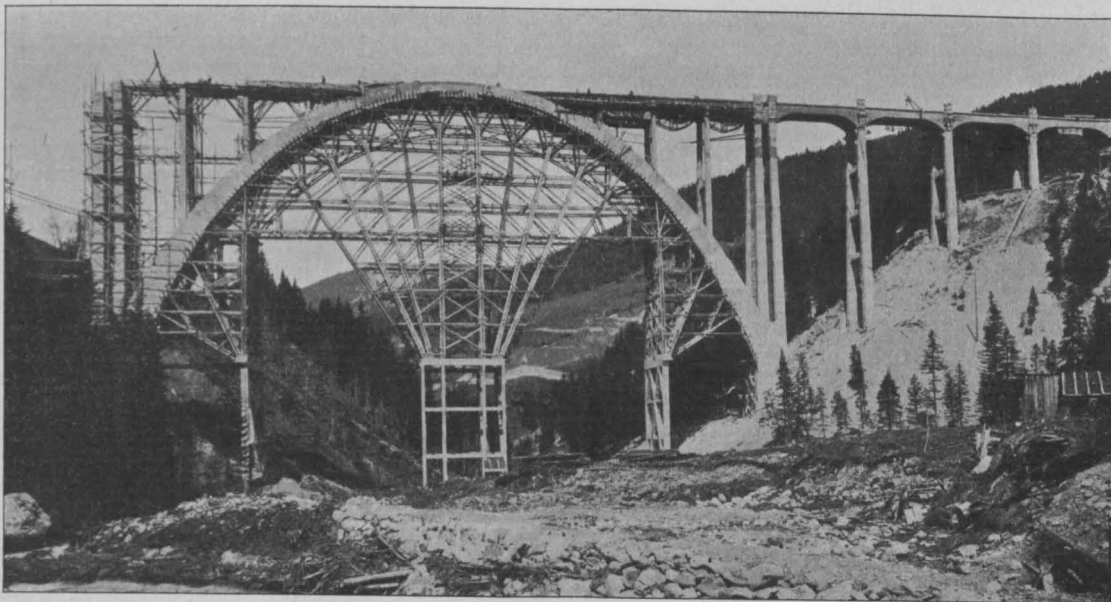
Herstellung des Fahrbahnaufbaues über dem Bogen. Nebenöffnungen auf Langwieser Seite ausgerüstet. — Blick talauswärts. Bauzustand im Frühjahr 1914.
